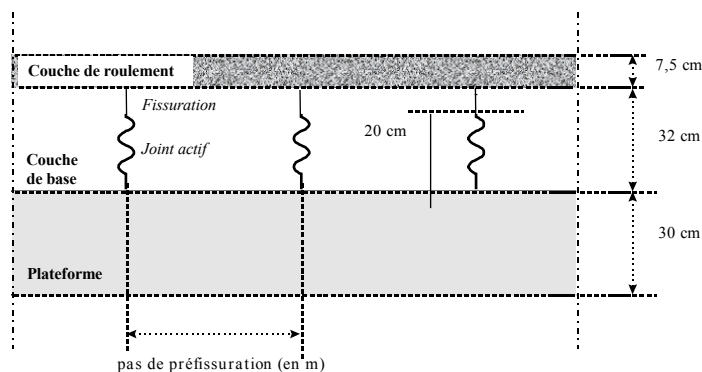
Schéma de principe d'une chaussée Joints Actifs®
